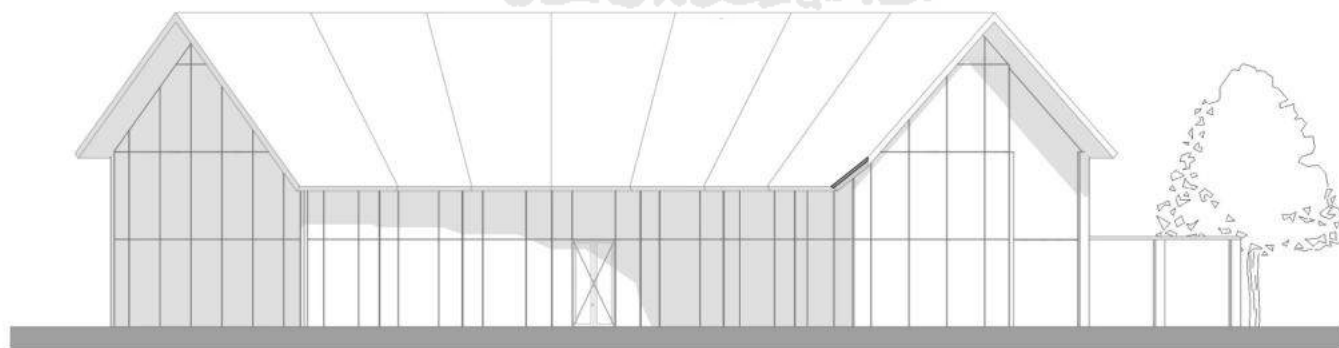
Tampak timur bangunan workshop (*Sumber: Penulis, 2021*)
